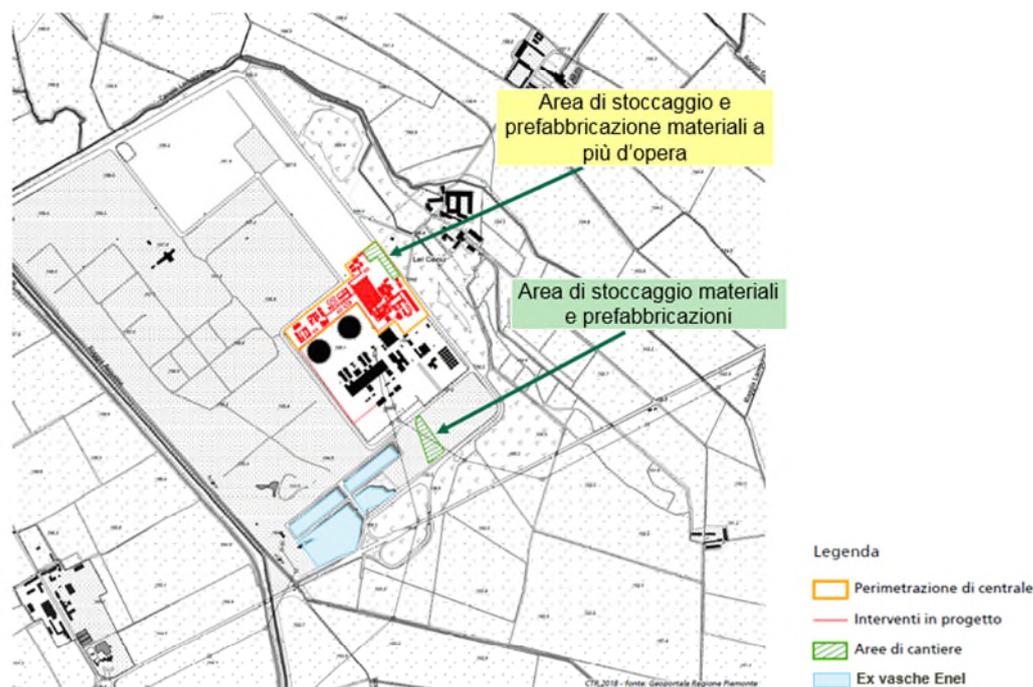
Localizzazione delle ex vasche Enel rispetto al sito di impianto e alle aree di cantiere
